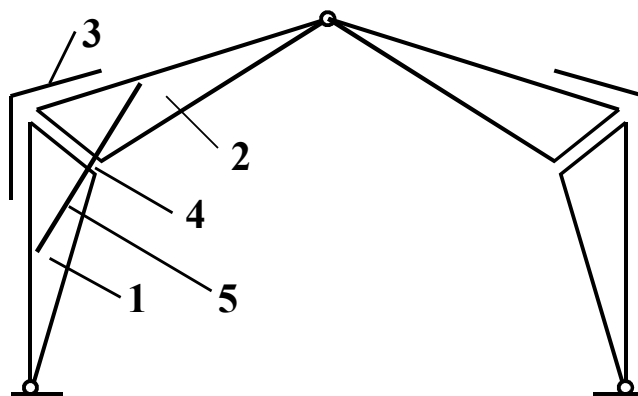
Схема рамы двутаврового сечения с двойной перекрестной стенкой на гвоздях
